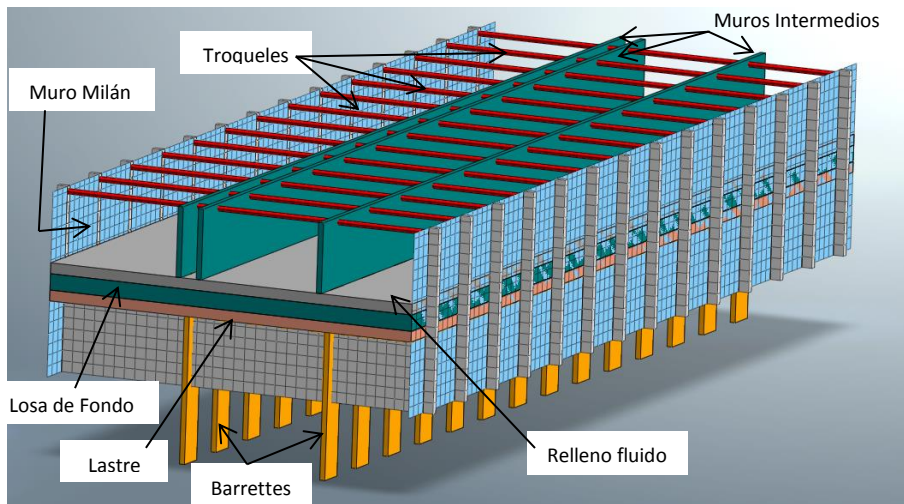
Arreglo tridimensional de la construcción de muros intermedios.
